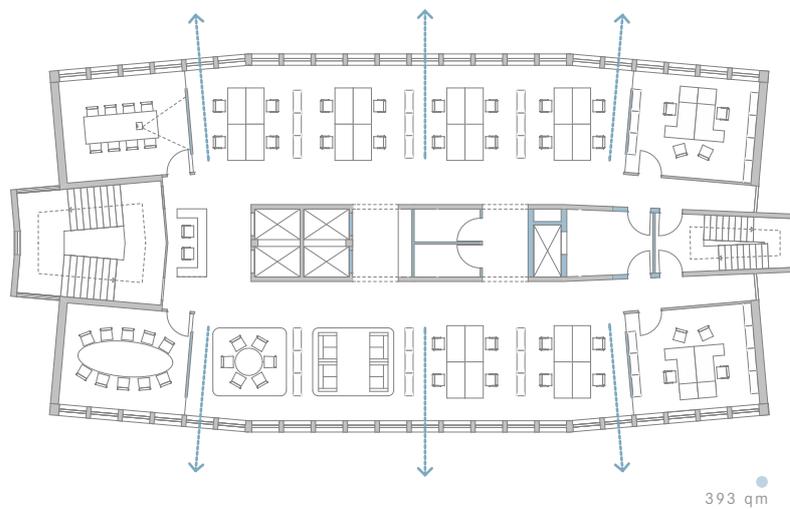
Grundriss Umbau - Grundrissaufteilung
